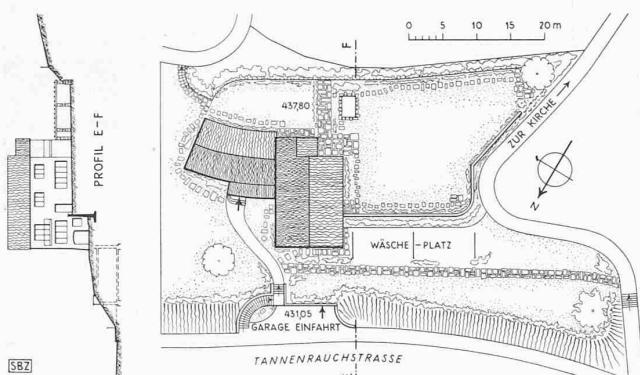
Lageplan 1 : 1000, mit Geländeprofil E-F
